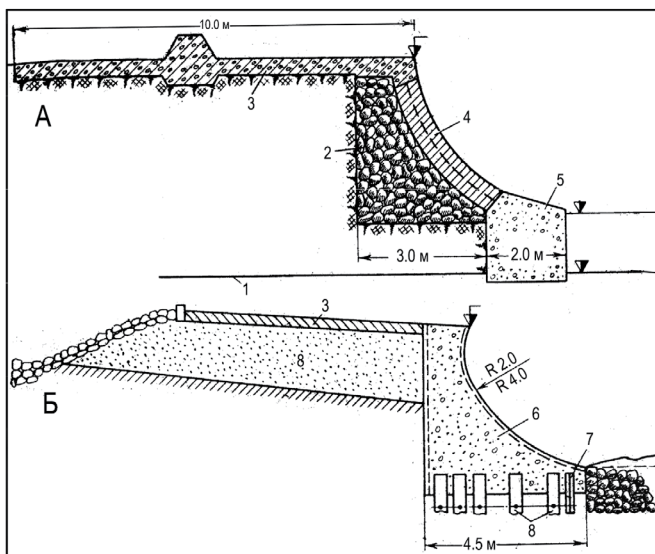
Берегозащитные стенки разных типов: А – монолитная бутобетонная стенка с зубом; Б – монолитная бетонная стенка на свайном основании. Цифрами показаны: 1 – скальное основание; 2 – бутобетонная стенка; 3 – бетонное покрытие; 4 – облицовка стенки из высокопрочного бетона и натурального камня; 5 – монолитный бетонный зуб; 6 – монолитная бетонная стенка; 7 – шпунт; 8 – свайное основание (Горюнов, Шихиева, 1970).
